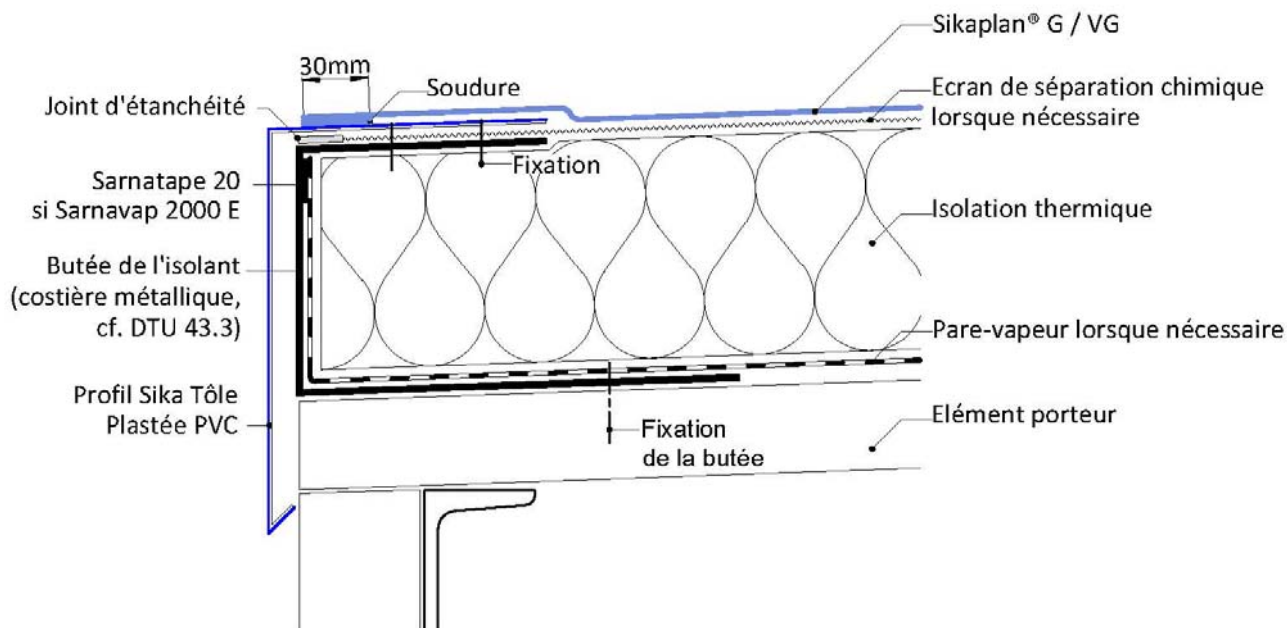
Rive plate avec profil en Sika Tôle Plastée PVC
